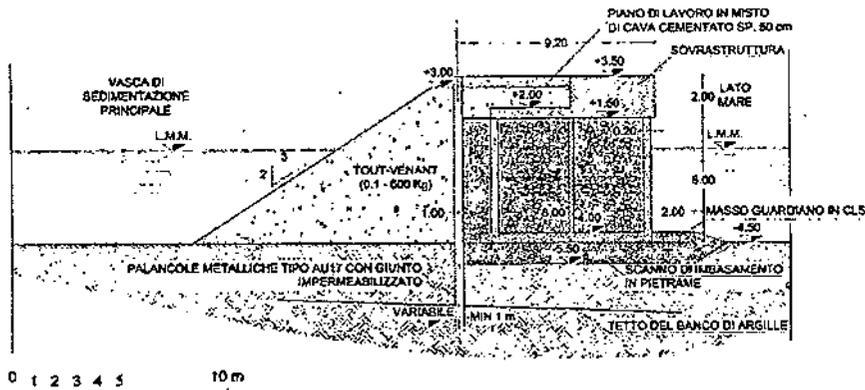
Sezione tipo B-B (banchina a cassoni)
